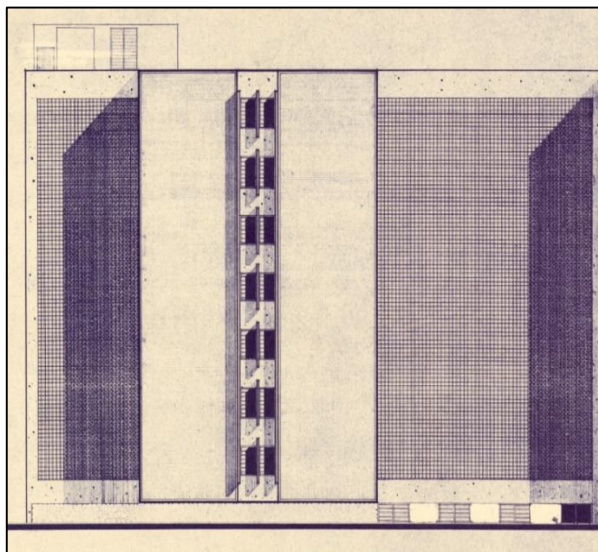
Elevación fachada posterior del Edificio del ala norte de la Facultad de Medicina (Sector Oeste) (Plano de la edificación, 1965)
